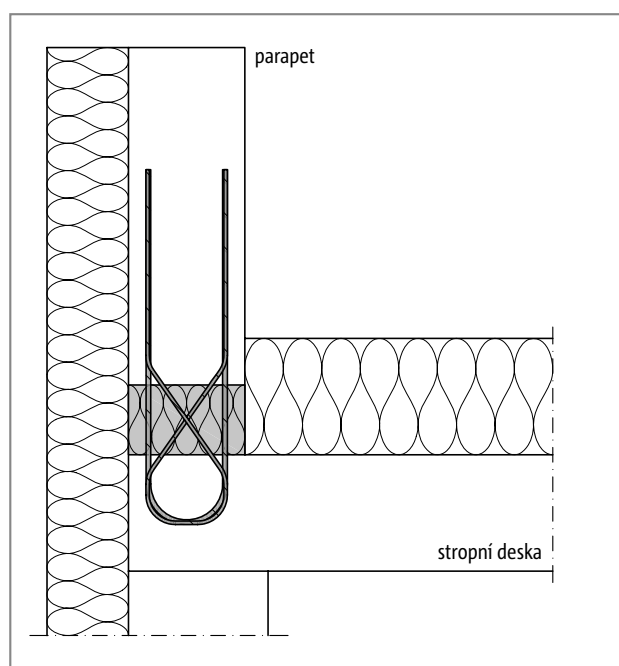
Schöck Isokorb® typ ABXT - vodorovné zabudování: Půdorys, před-sazení parapetu resp. atiky
